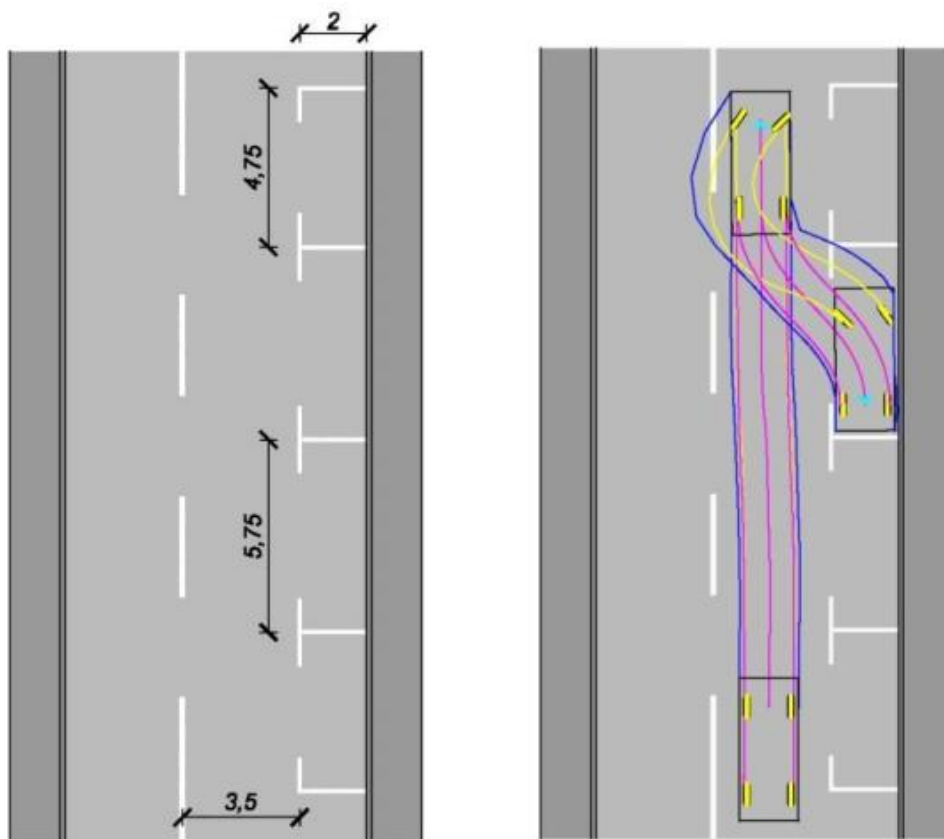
Dimenzije crta za označavanje mjesta za parkiranje, [2]
